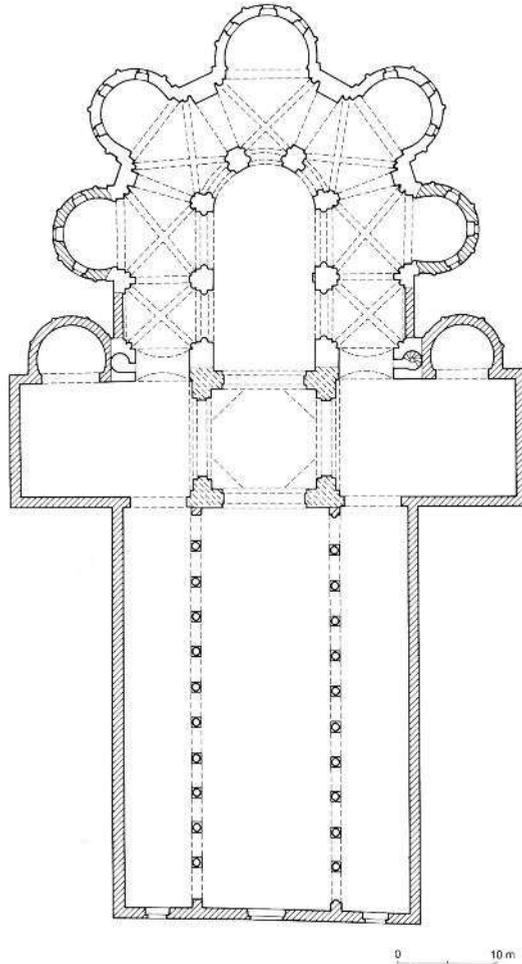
Restituzione planimetrica della cattedrale normanna di Aversa
